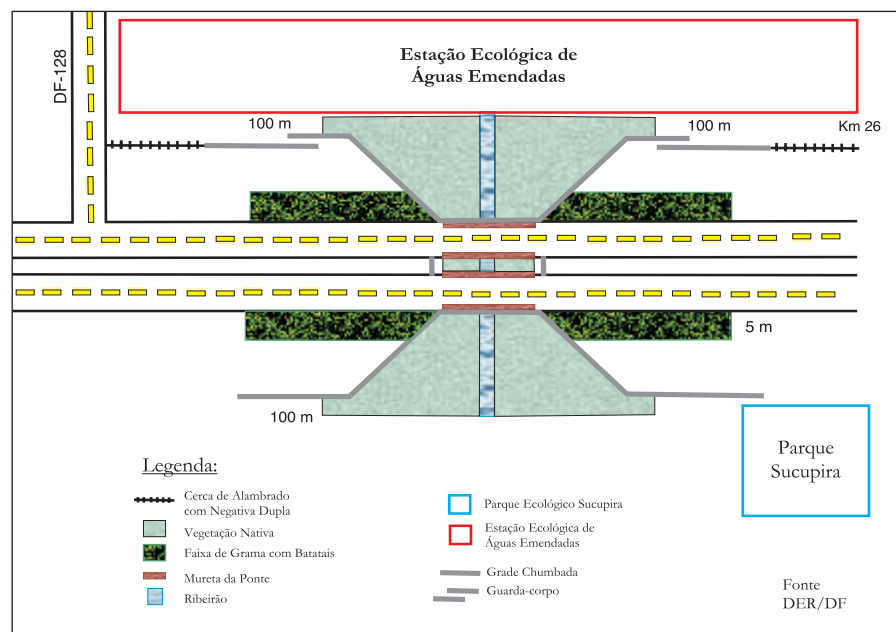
Passagem do tipo ponte sobre o Córrego Fumal.
